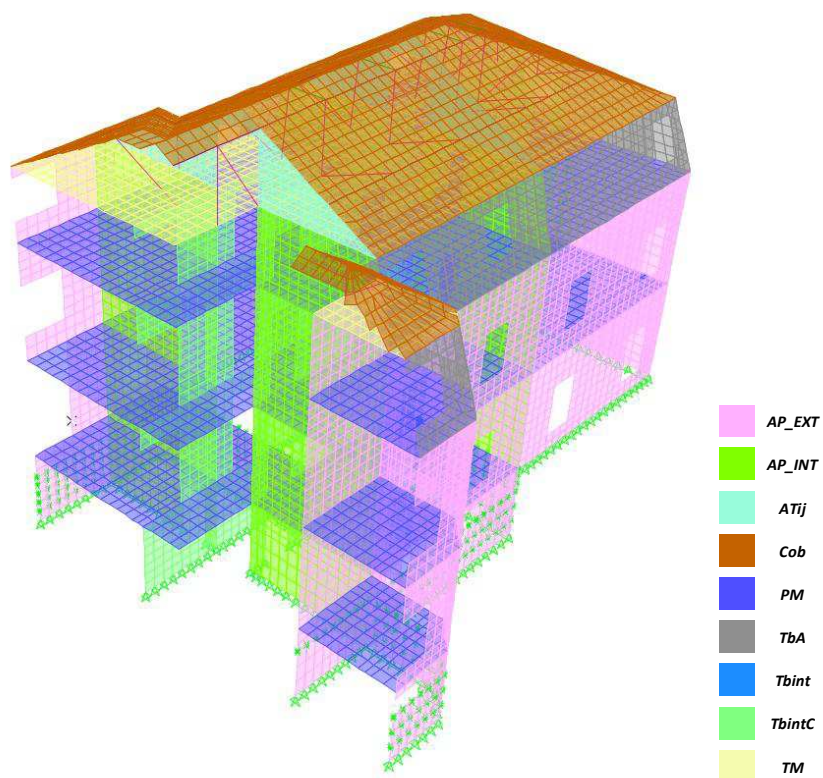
Perspetiva com corte transversal na zona das escadas principais.
